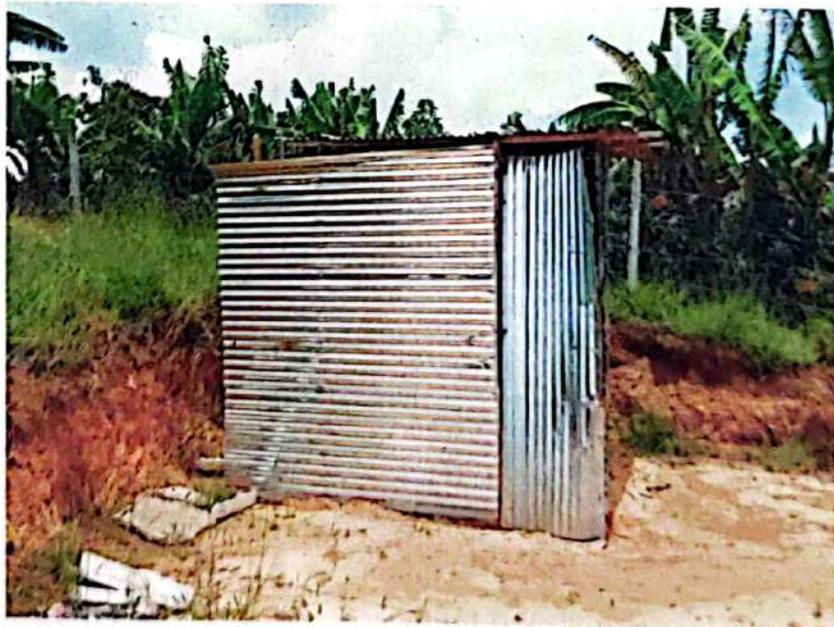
Vista del corte de la vía de acceso a la vivienda en estudios, el cual no llegó hasta su culminación.
